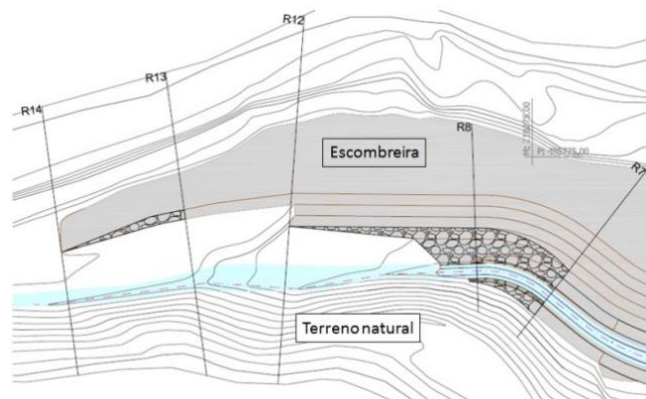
Planta geral da obra de ligação da Ribeira de Levadoiro ao canal 1.
